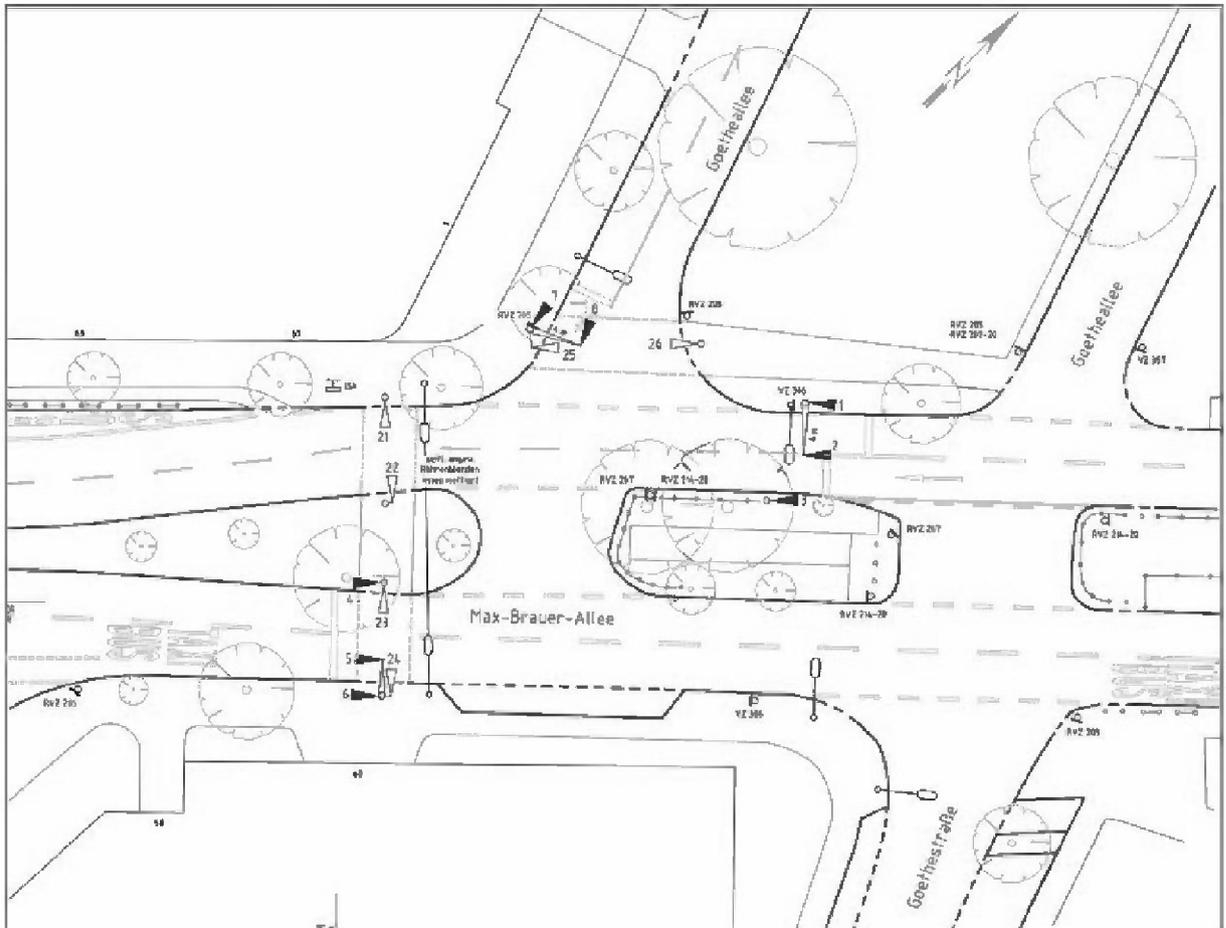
3 Signallageplanausschnitt LSA 1771
